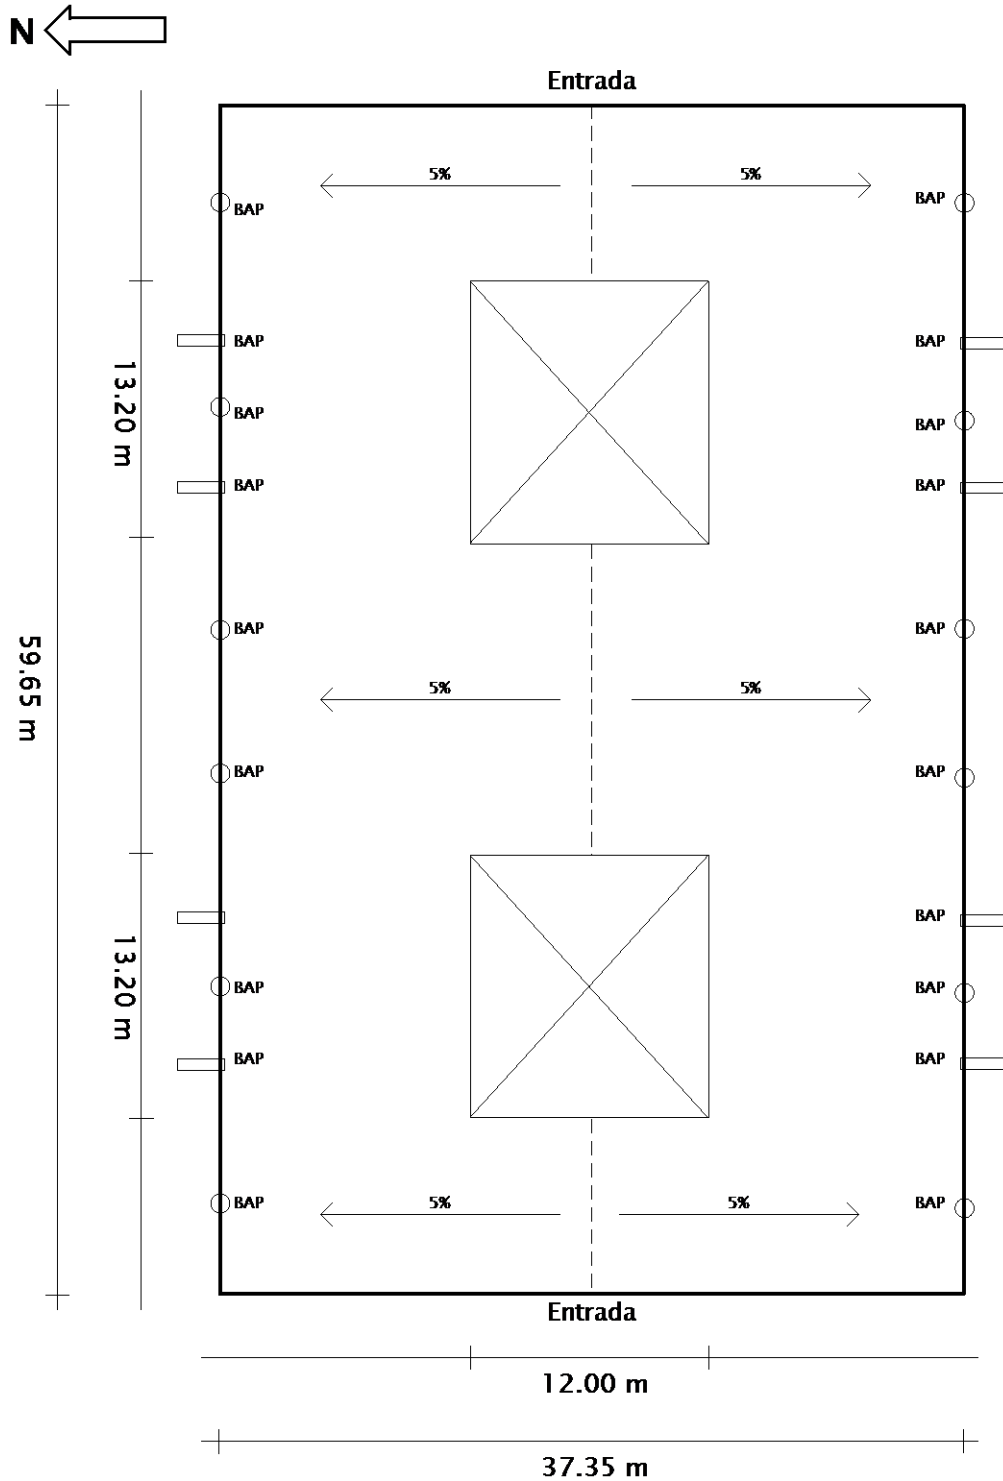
Vista en planta de la azotea del edificio “C” (fuente: elaboración propia).
